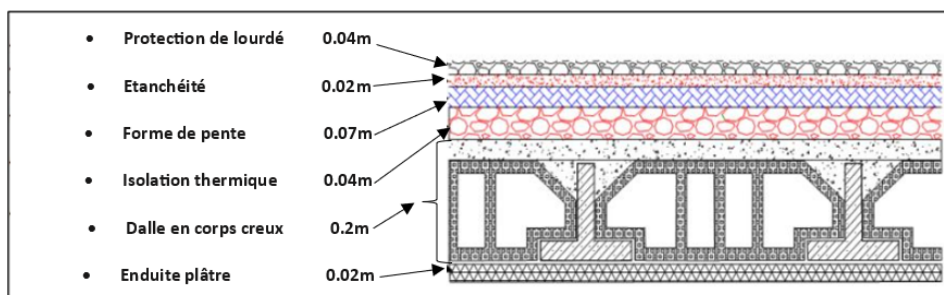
Schéma représentant les couches d'un plancher de terrasse inaccessible
